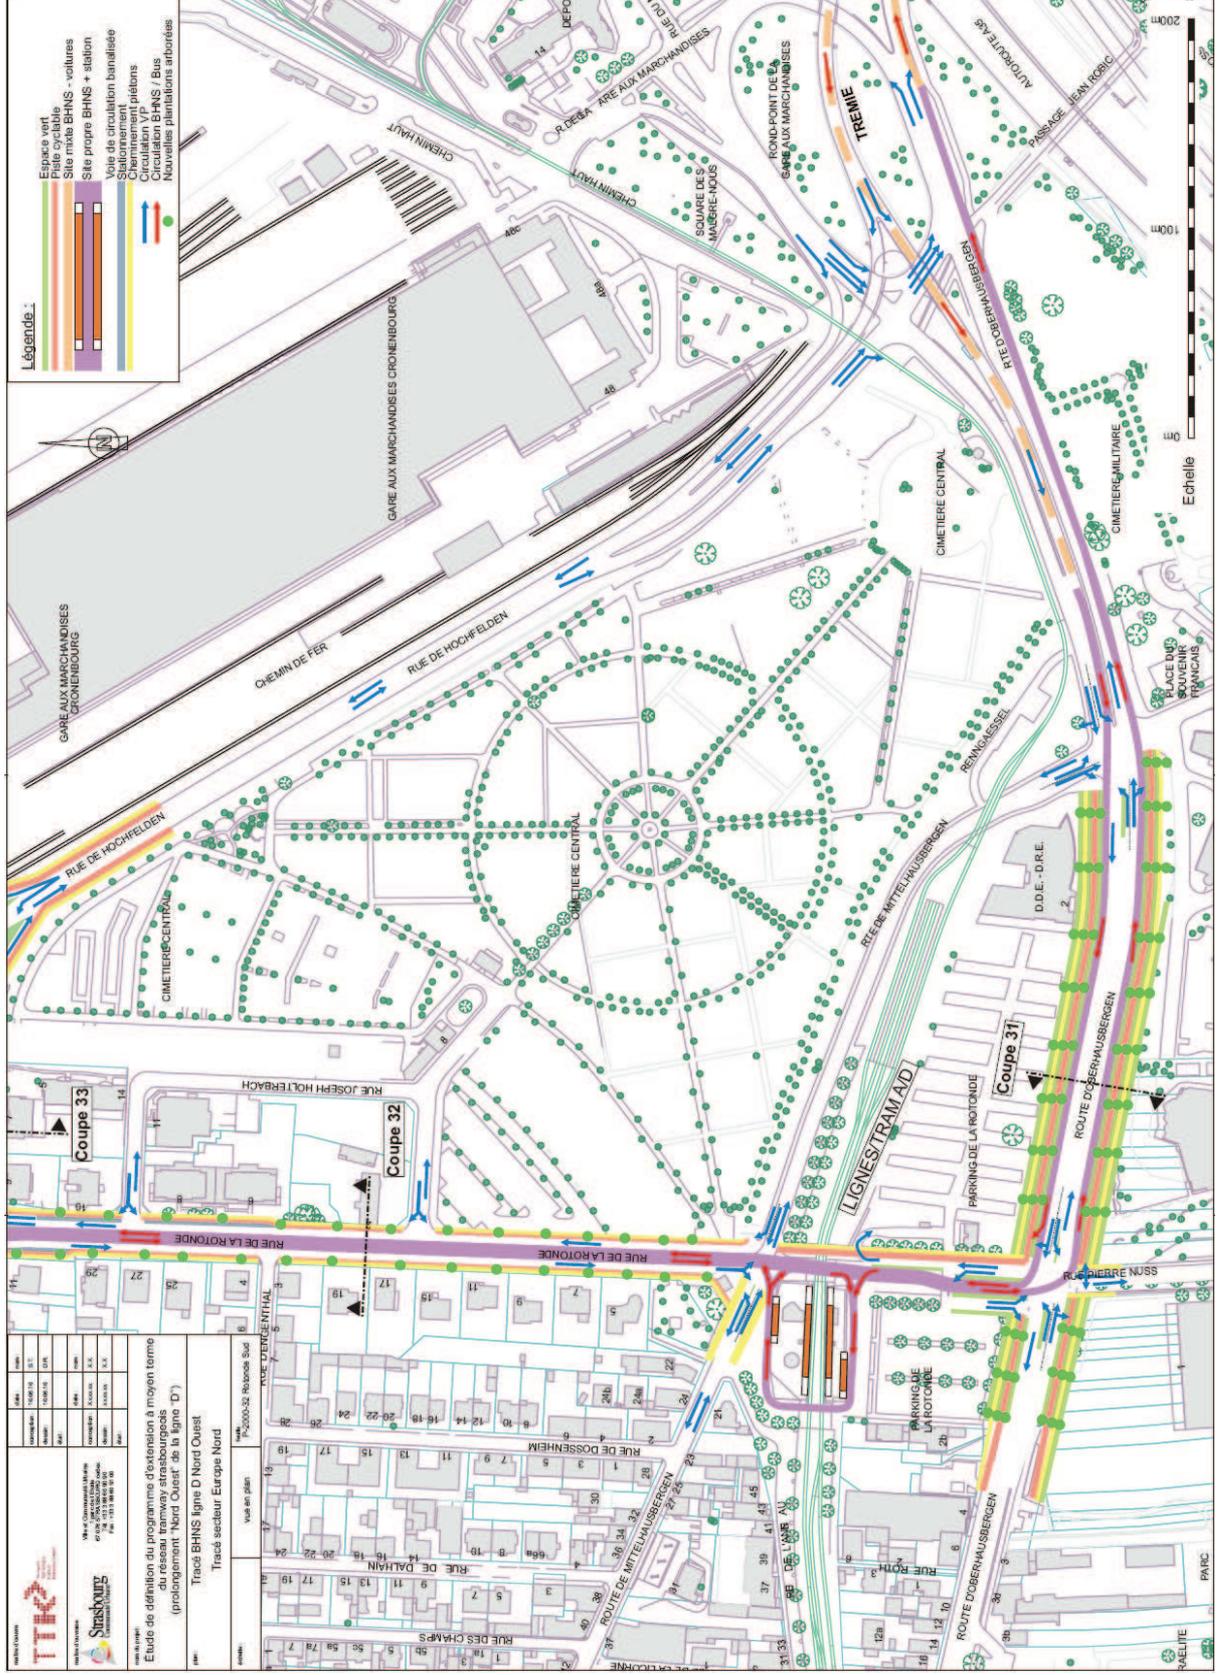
Plan d'insertion du secteur "Rotonde Sud" (échelle 1/2500^{0ms})
